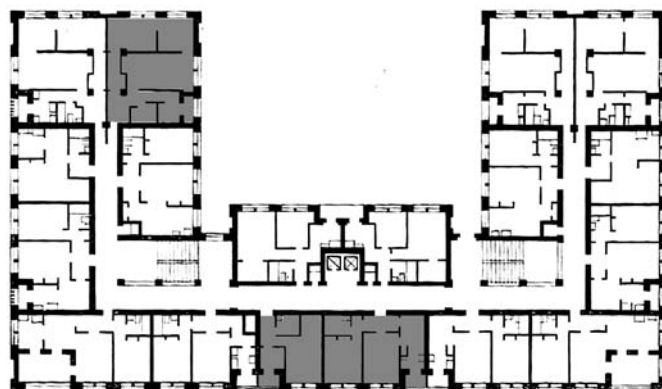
План типового этажа жилого дома на Ленинградском шоссе
